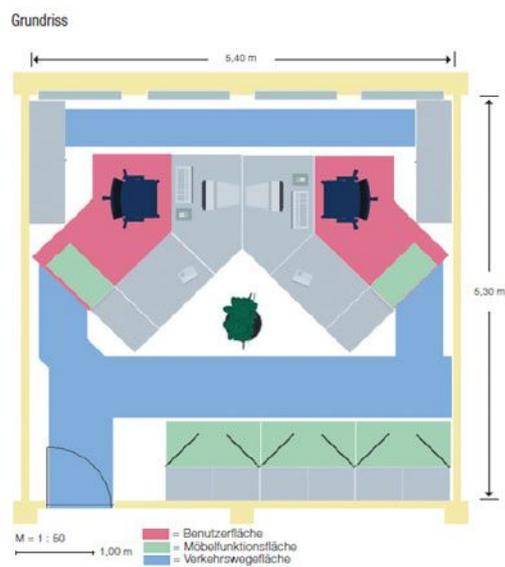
Zweipersonenbüro – Grundriss
